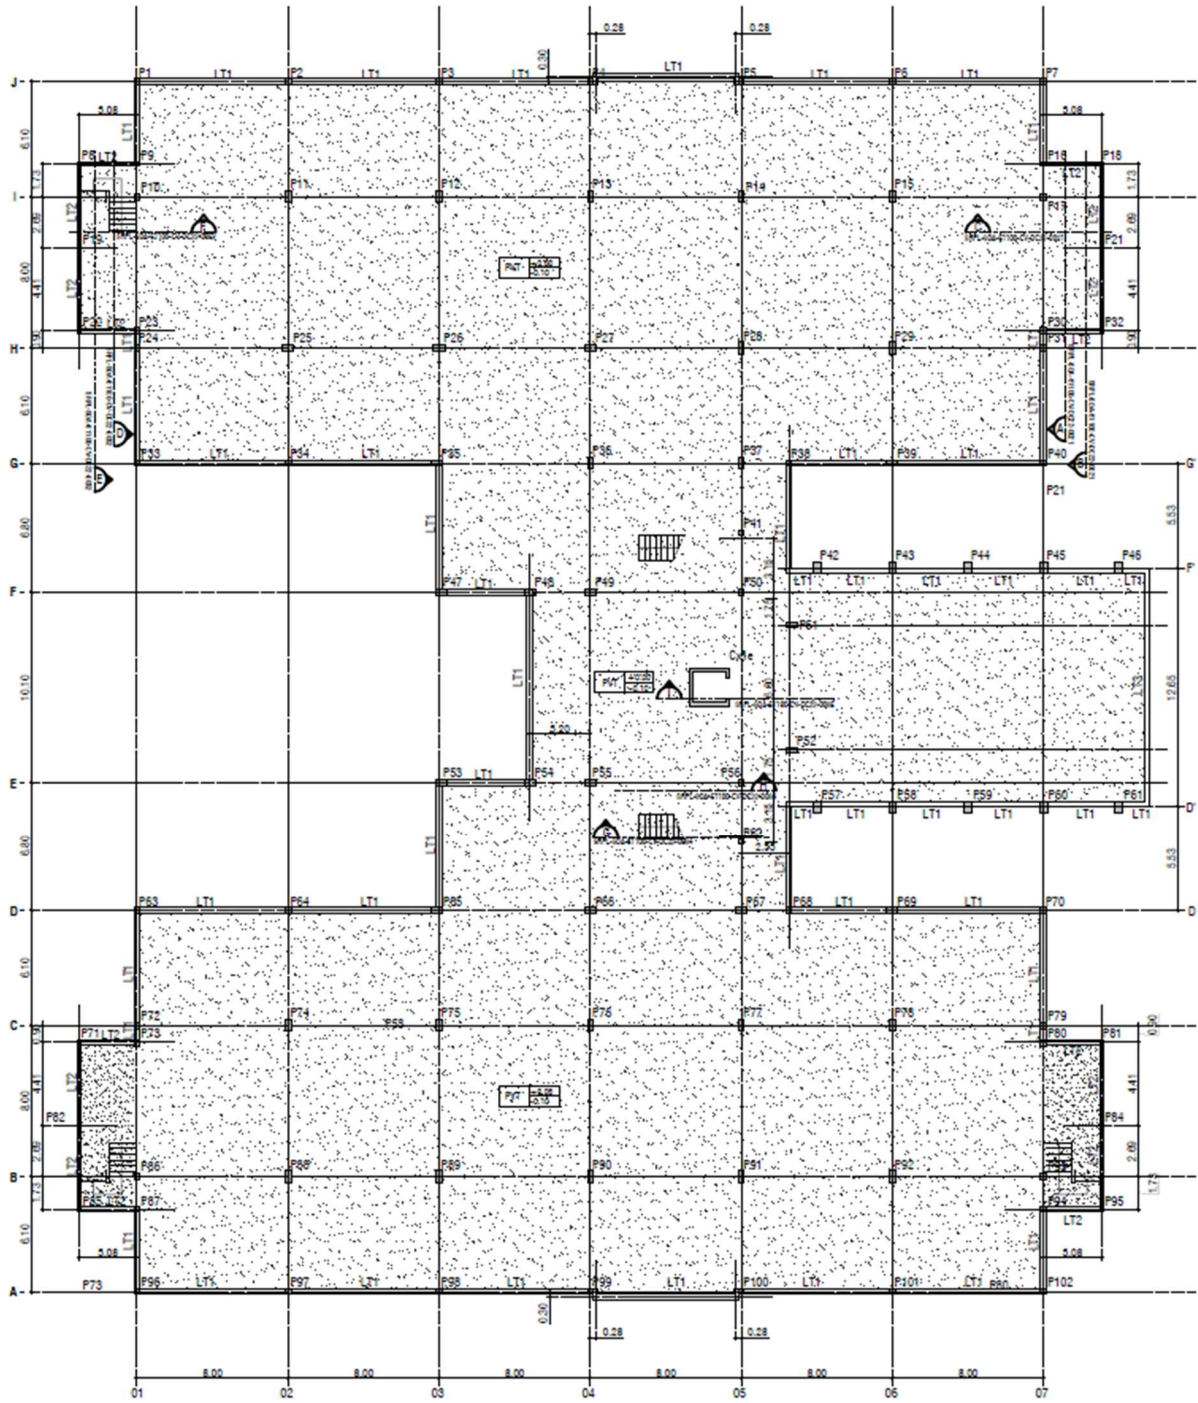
Planta Pavimento Térreo do Projeto Executivo
